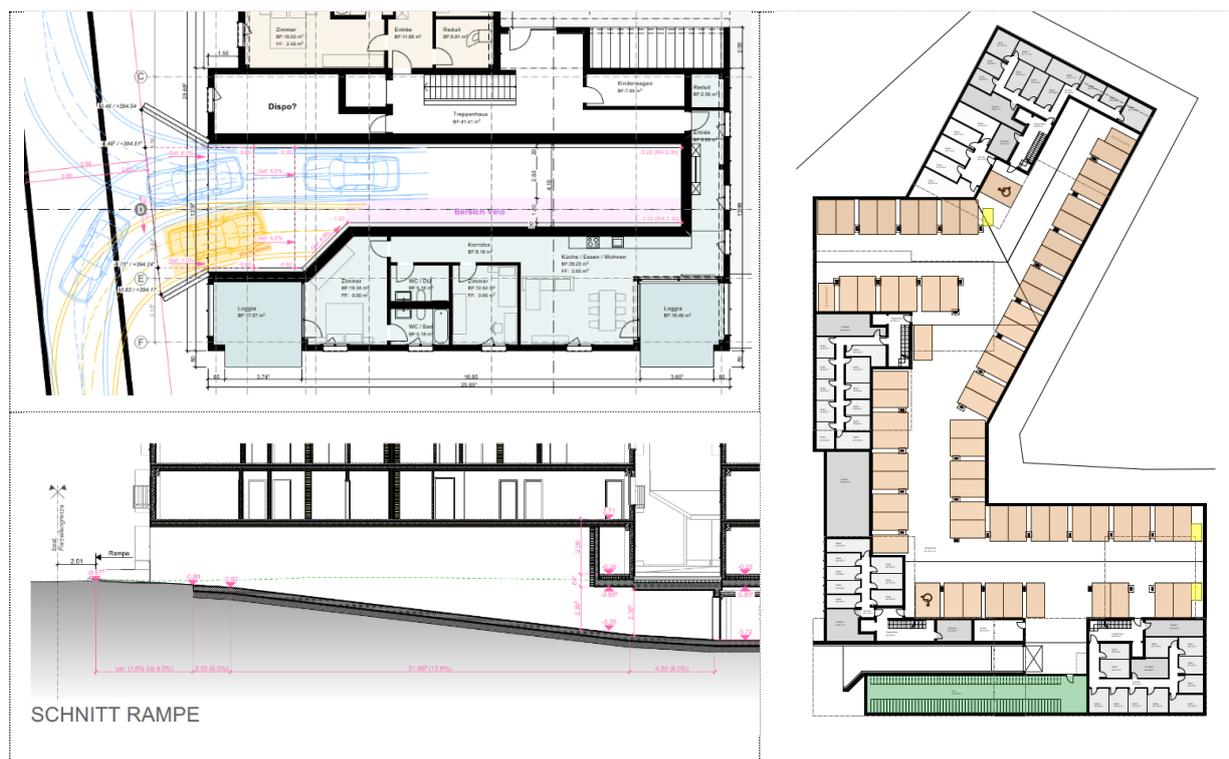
Zufahrt Tiefgarage und Parkieranordnung gemäss Richtprojekt Bebauung (Strüby Konzept AG)
